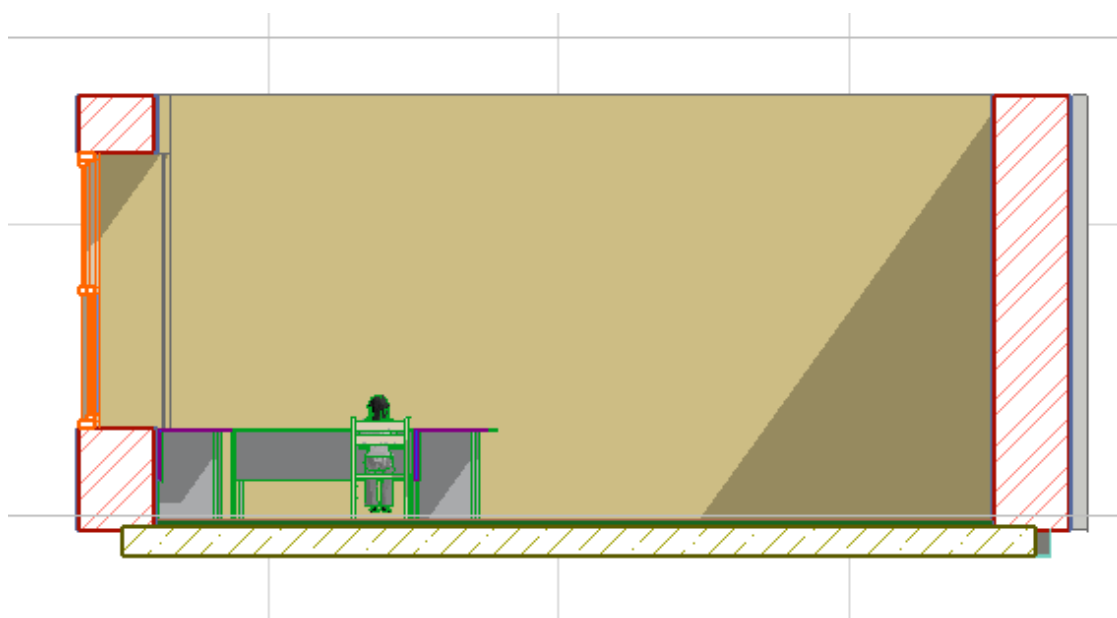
Поперечный разрез помещения с указанием рабочего места относительно оконных проемов
